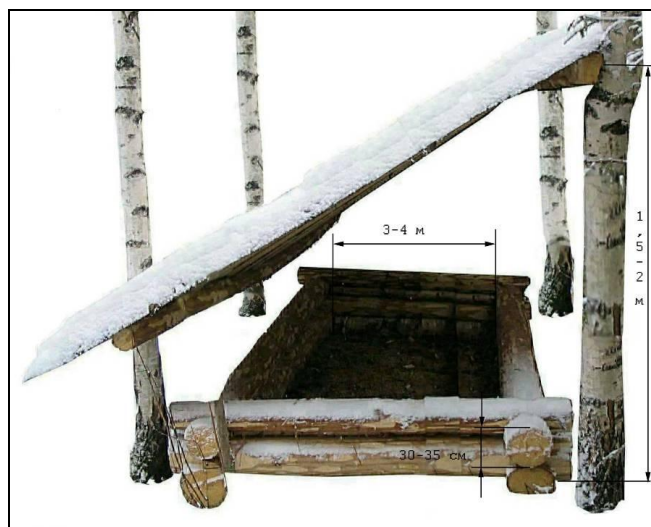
Общий вид галечника с порхалищем для боровой дичи
